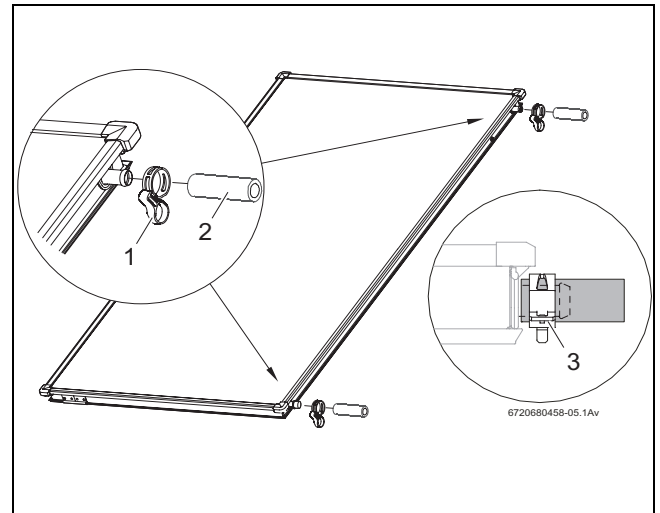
Montaje previo del juego de conexión en el segundo colector
